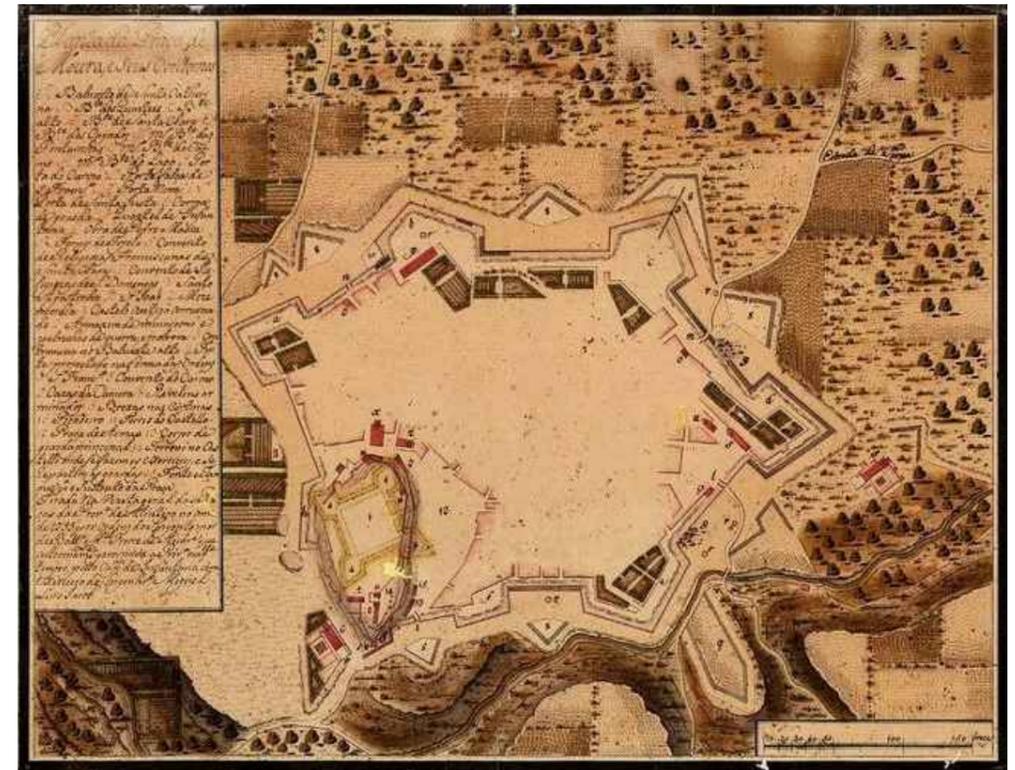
Planta da Praça de Moura, Miguel Luiz Jacob, coleção de plantas de praças do Alentejo, 1755
